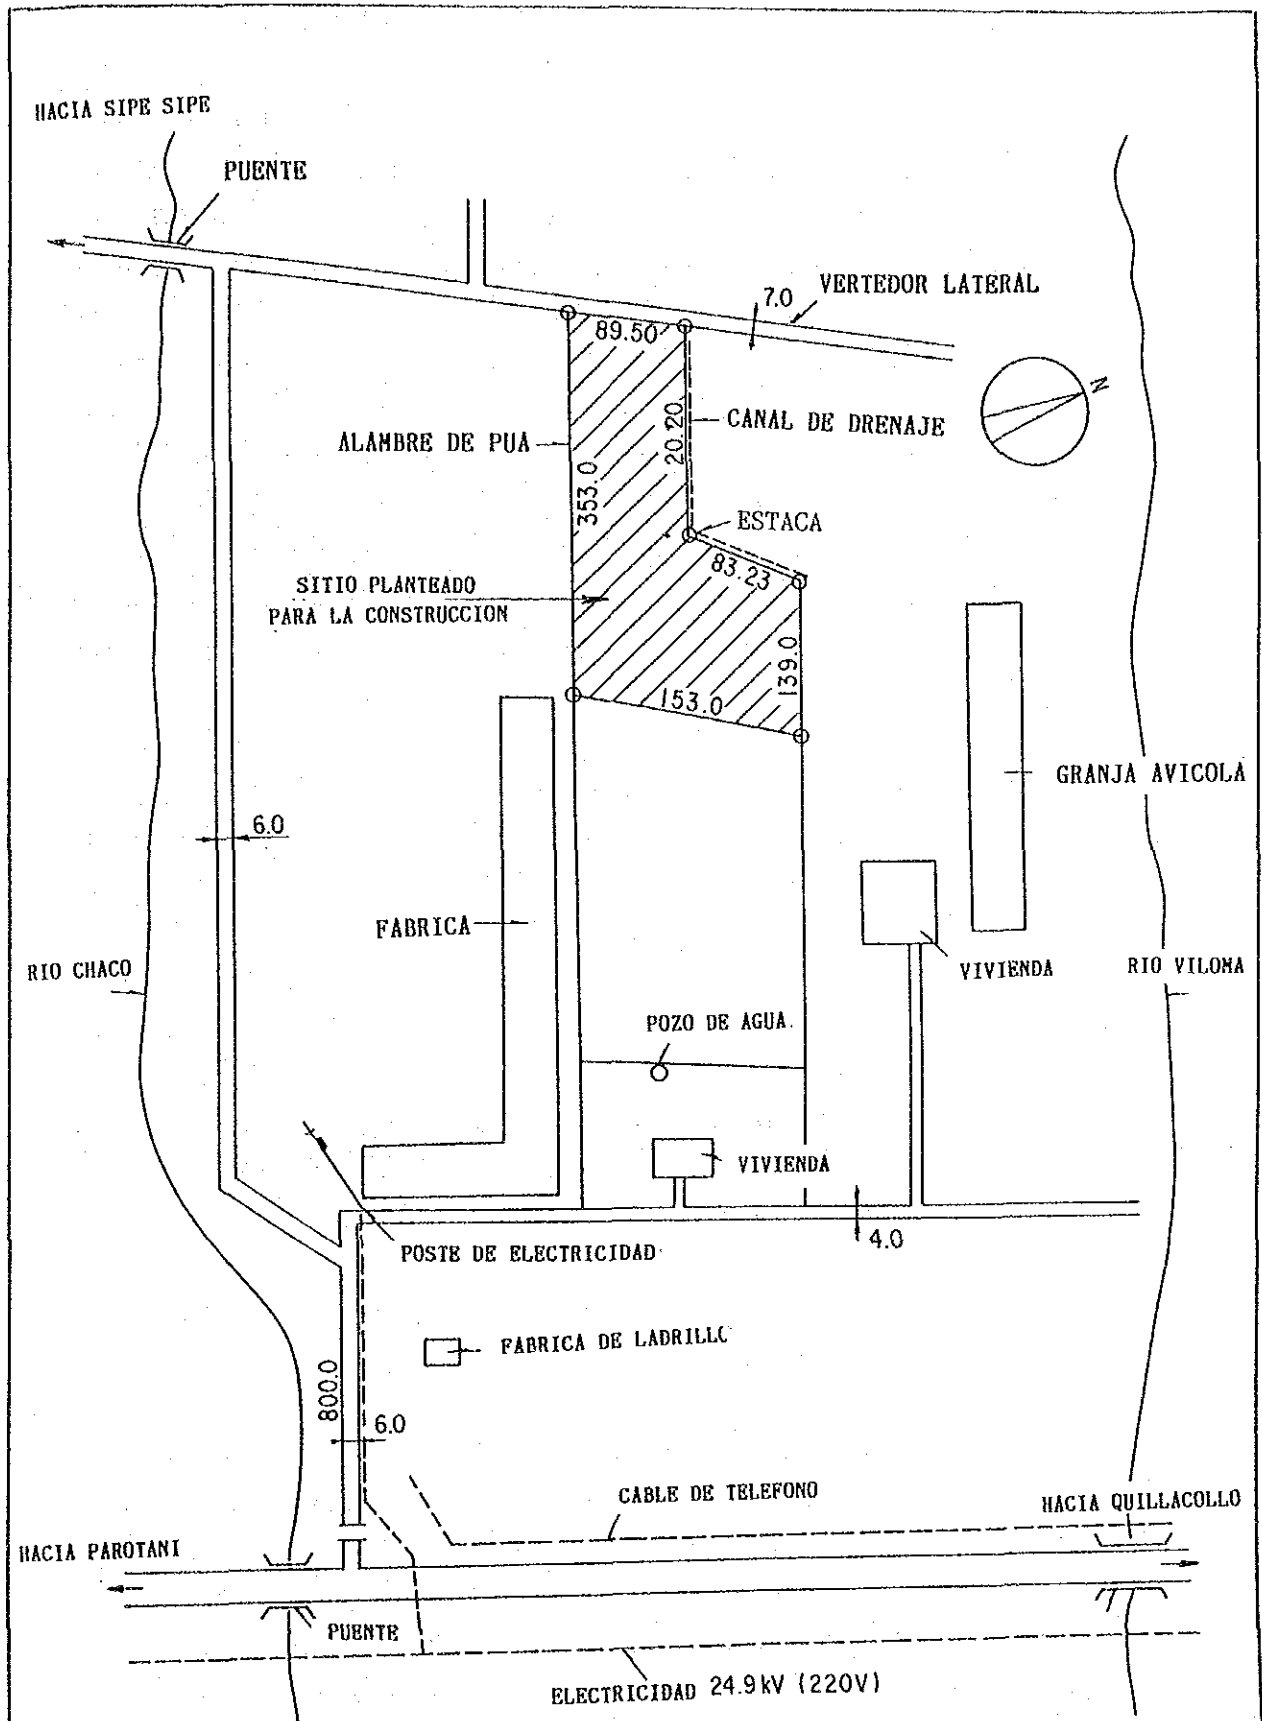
Sitio Planteado para la Construcción del Centro de Semillas de Hortalizas
